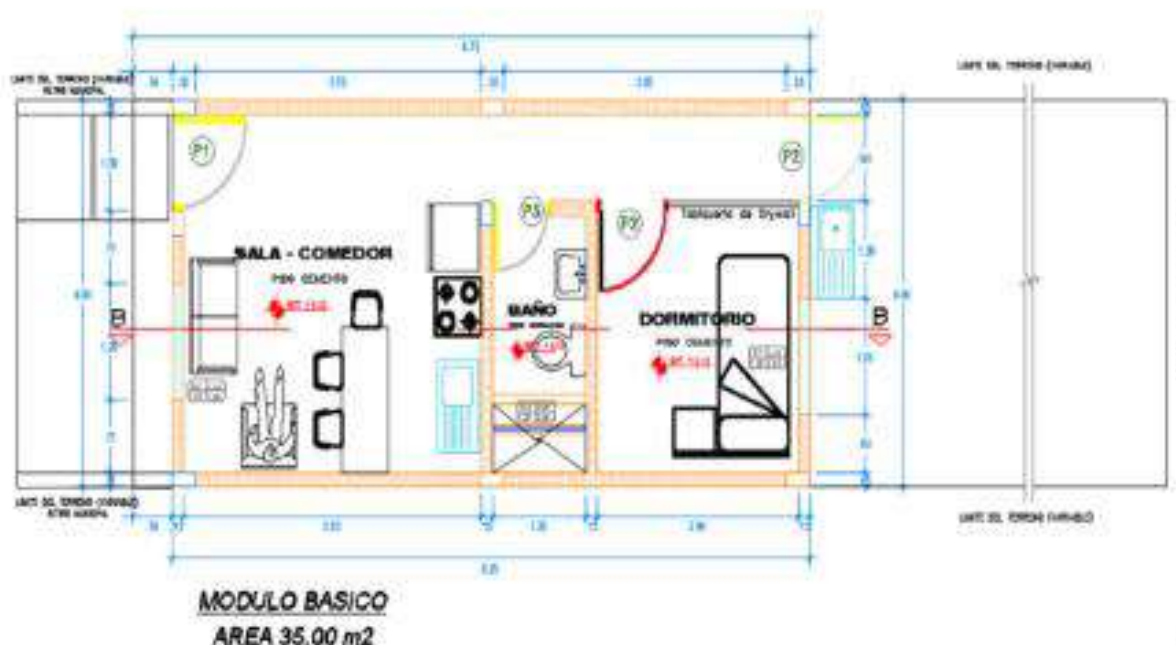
Plano del módulo básico de la modalidad de construcción de sitio propio
